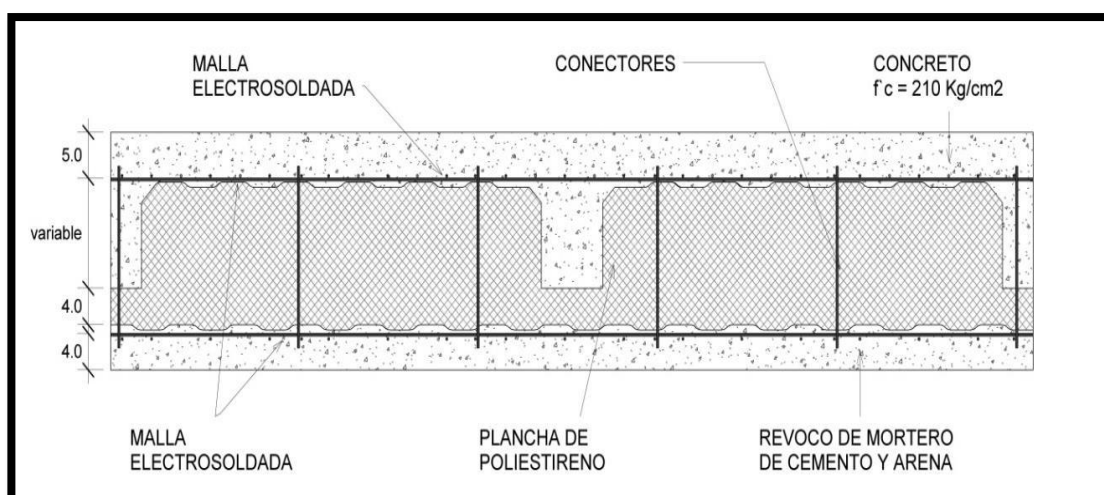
12 Panel de losa con nervadura para armado de viga PL1
